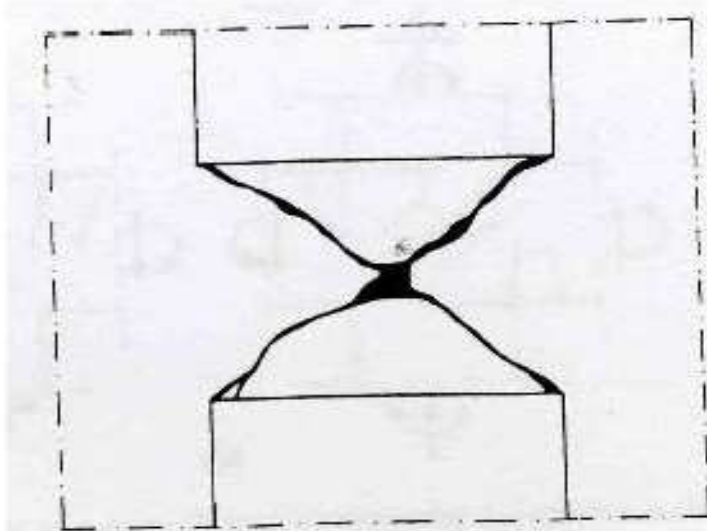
Fissures de cisaillement de forme X dans les poutres courtes (linteaux).
